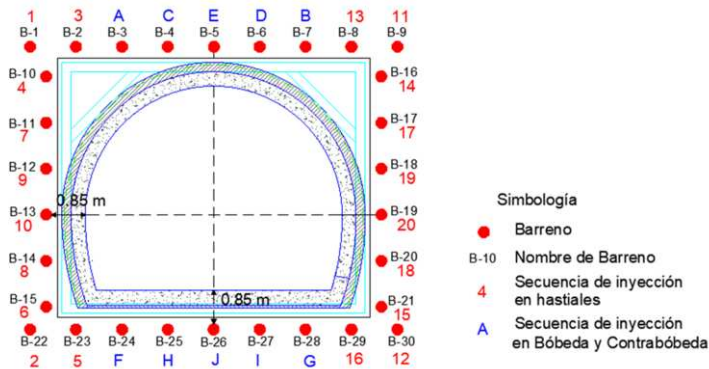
Diseño de plantilla de barrenos de inyección para tratamiento de impermeabilización previo al corte de las dovelas, [2, 3].
